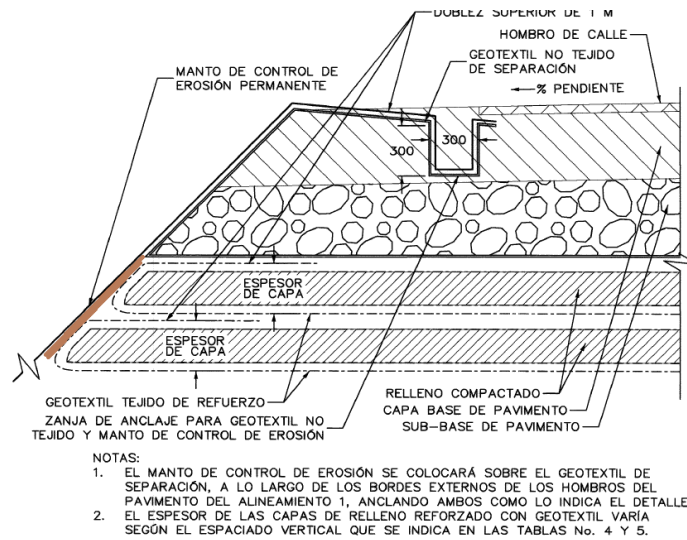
Sección típica de colocación de refuerzo y manto para control de erosión (ACP)
